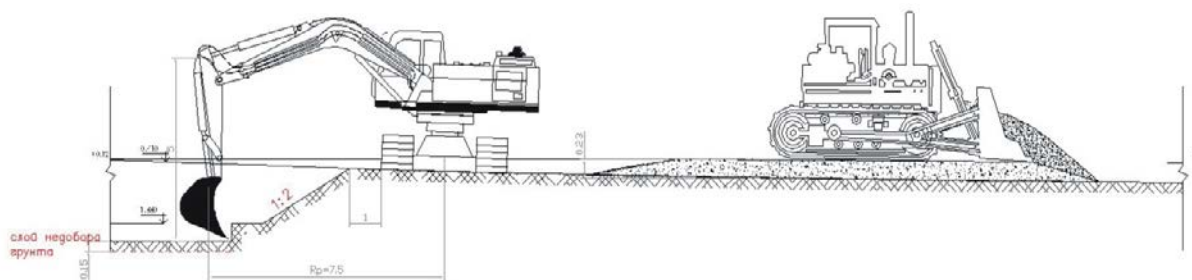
Разработка грунта экскаватором и его перемещение бульдозером в ПН
